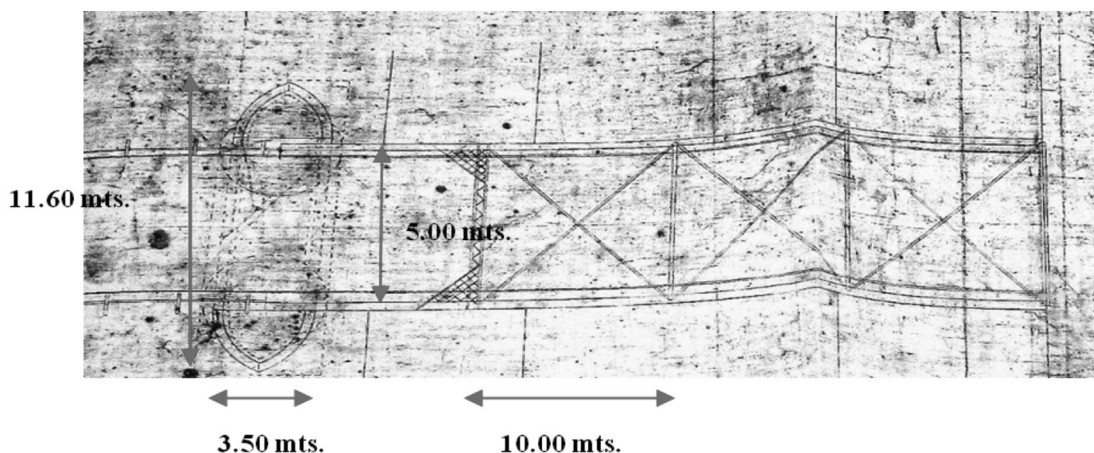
Plano de obra. Planta. Fuente: (planos) Dirección de Hidráulica Sección Dolores.
